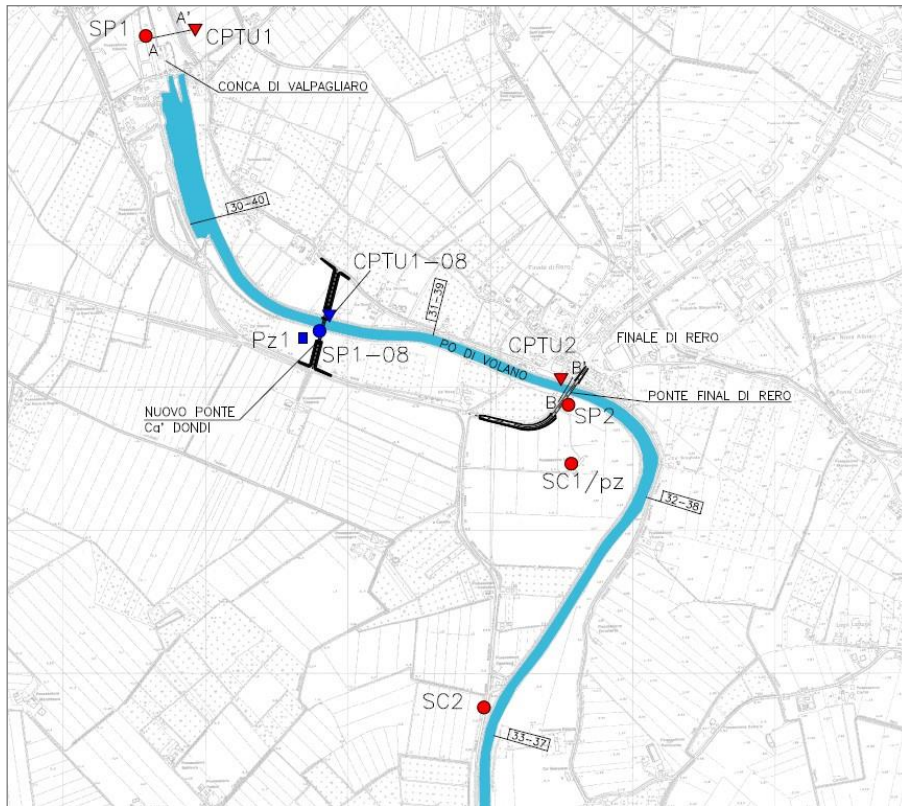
Stralcio planimetrico ubicazioni indagini 2004 e 2008
